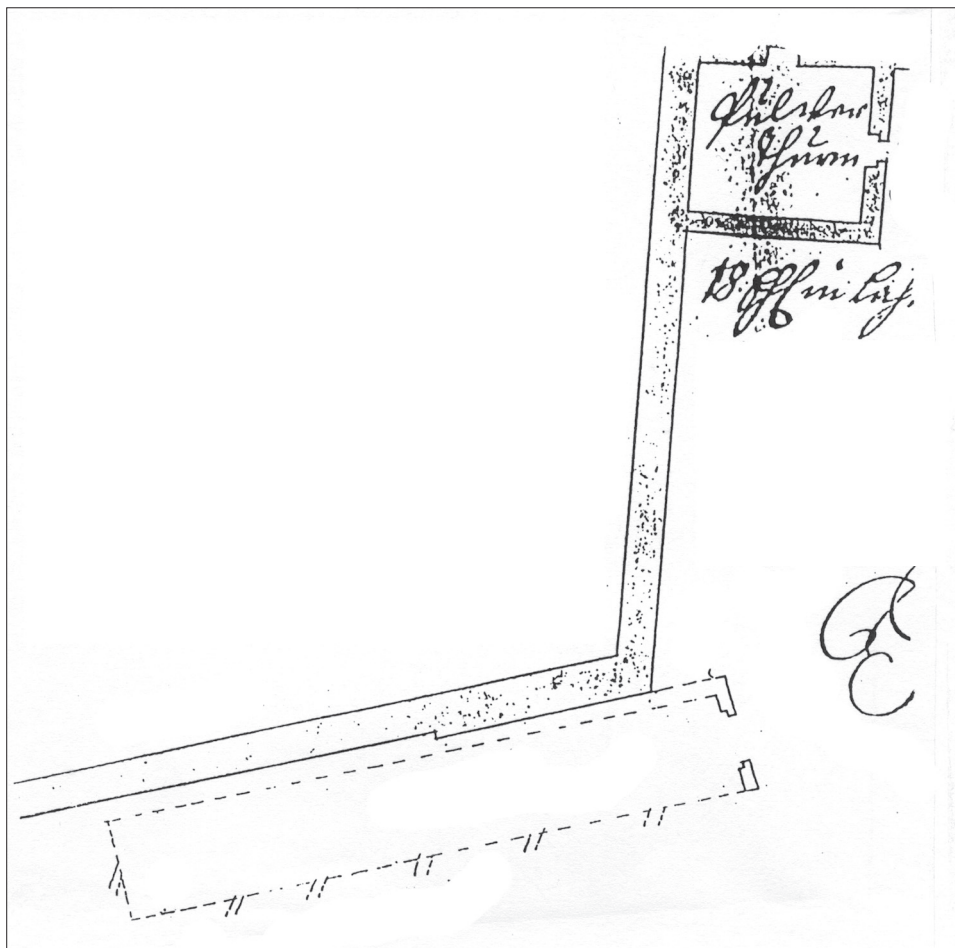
Prag 2-Vyšehrad. Grundriss des alten Burggrafenhauses, ursprünglich Palas von Karl IV., von dem Messer Dinebier aus den Jahren 1722–1748. Archiv der Prager Burg, Sign. 185, Alte Plänesammlung.
